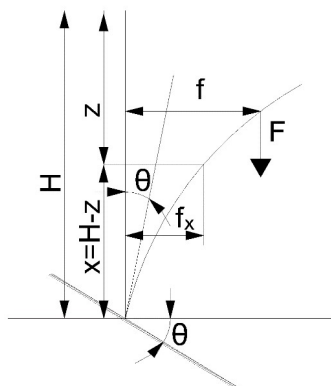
Расчетная схема прогиба трубы от действия ветровой нагрузки с учетом крена фундамента
